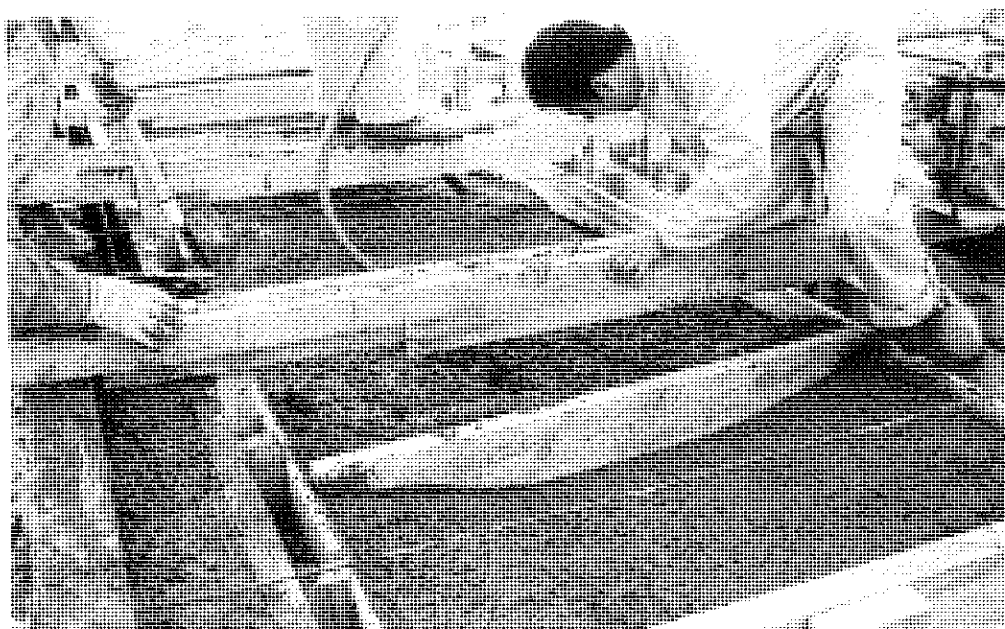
Ejecución Viga placa para paso de trenes. Medina del Campo.
